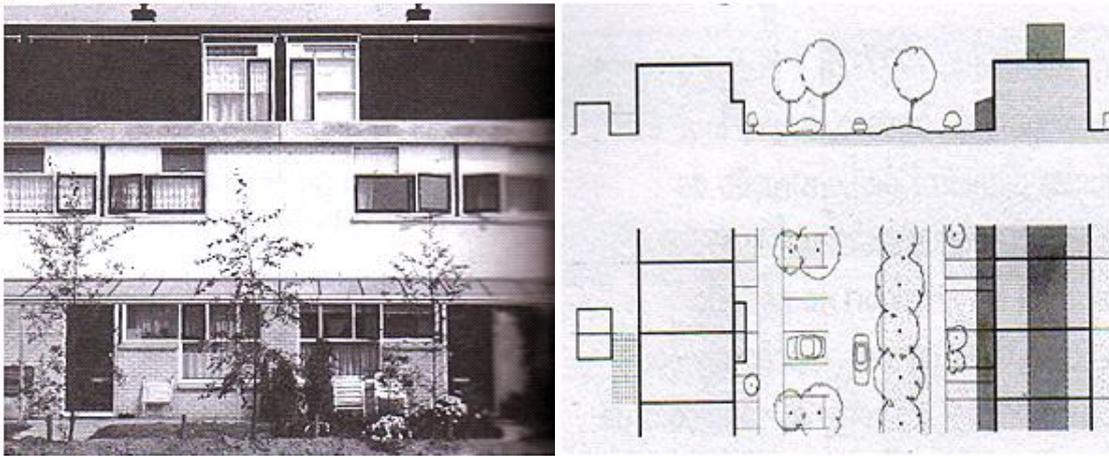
Het Gein Moradias, Holanda. Uso das fachadas e planta esquemática.
